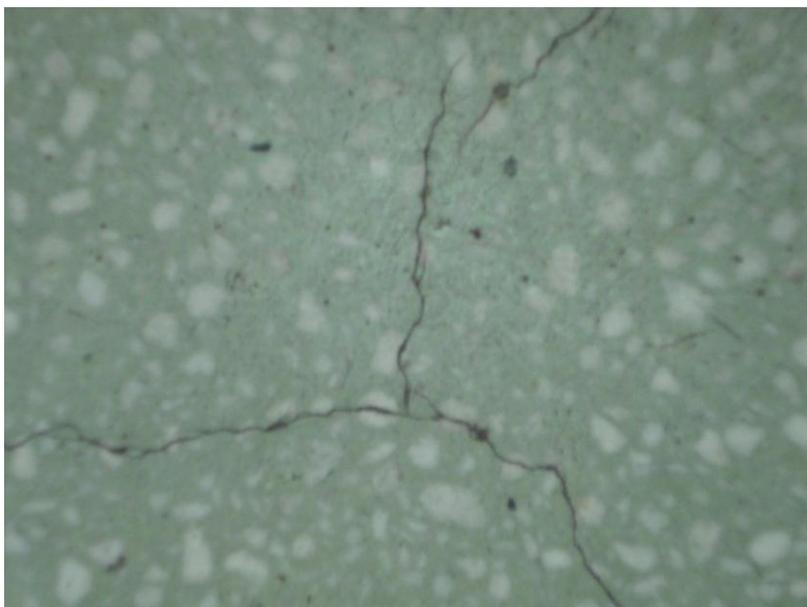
Piso interno original, após recuperação – fissuras não preenchidas.
